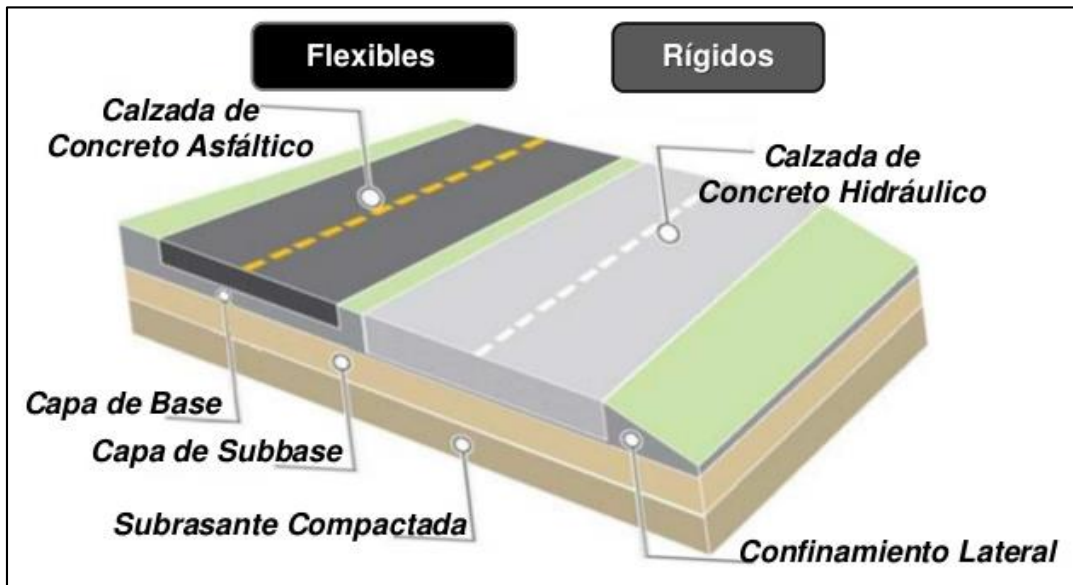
Esquema de los elementos que conforman un pavimento flexible y un pavimento rígido
